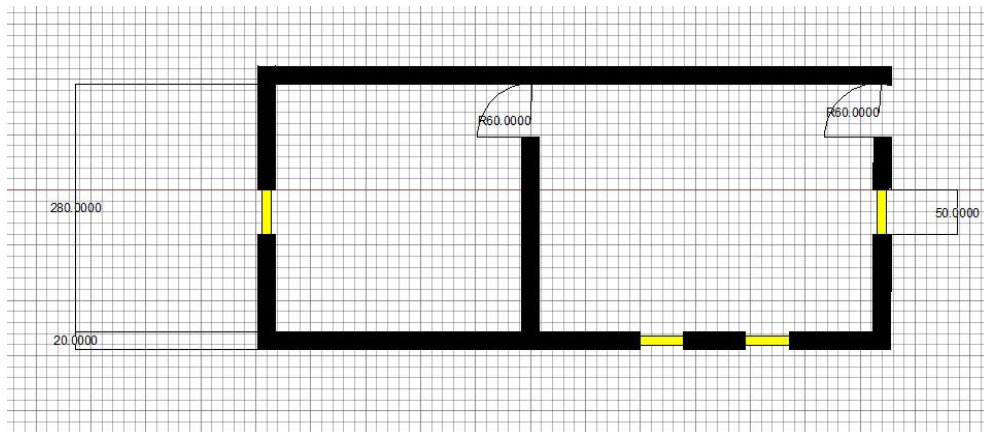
Exemplu de plan al unei locuințe realizat cu AutoCAD.
